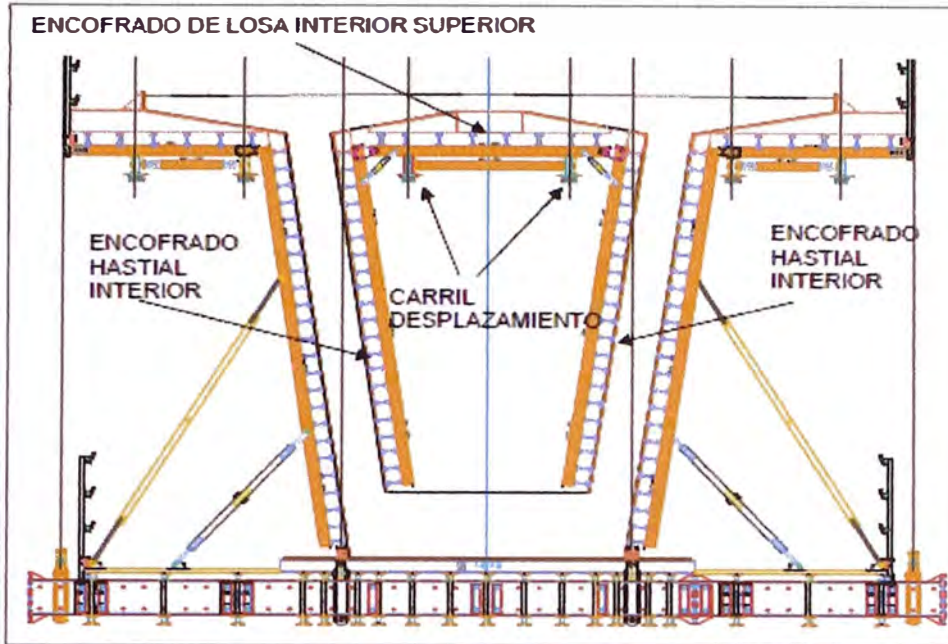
Vista sección encofrado interior, exterior y fondo.
